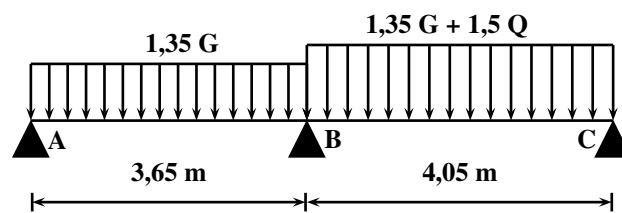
Poutrelle type 1 - cas 2 (ELU)
